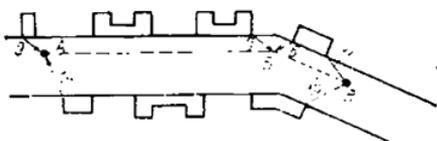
Схема разбивки трассы газопровода от местных сооружений
